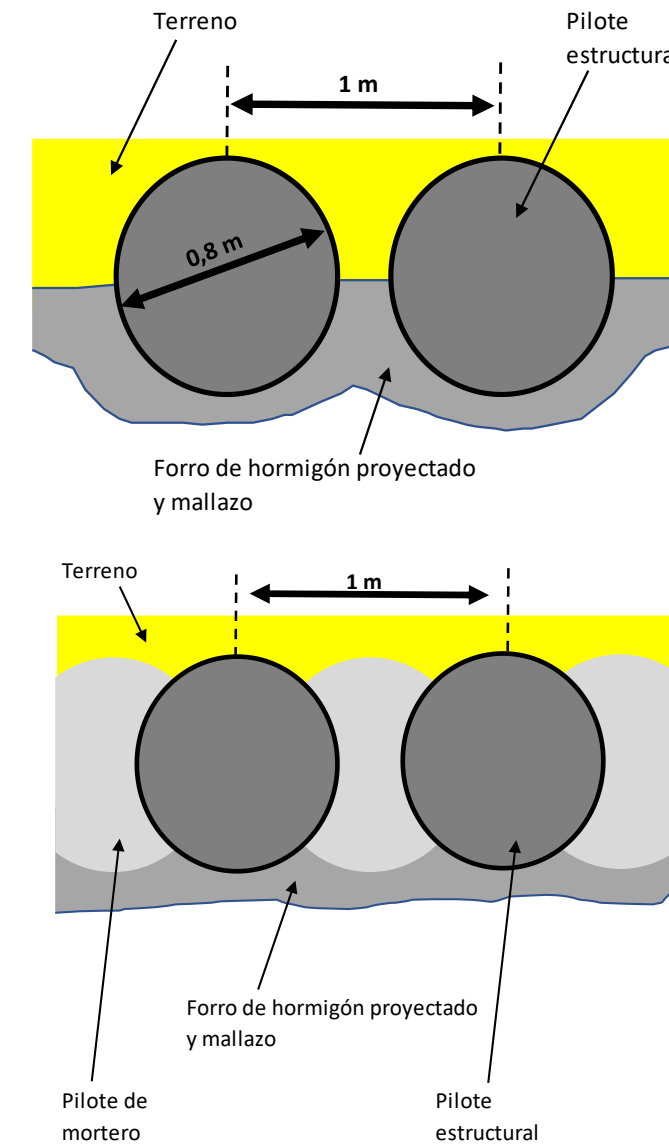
Pilotes en zona sin freático (croquis superior) y con freático (croquis inferior).
